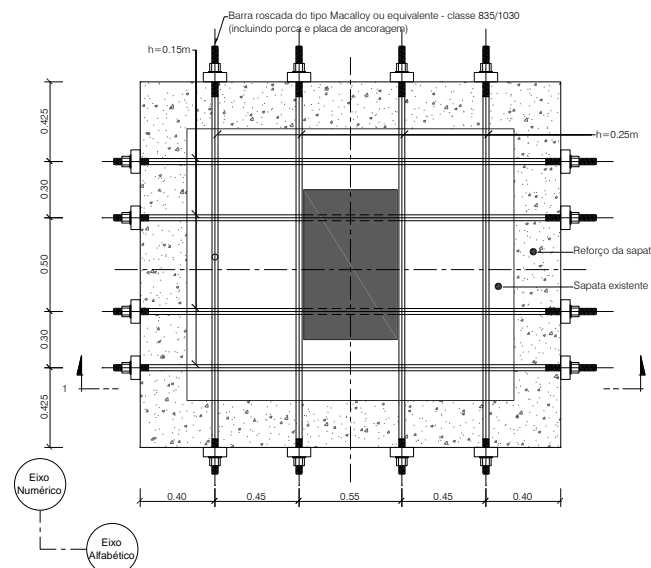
Pormenor tipo do reforço das sapatas existentes – planta.
